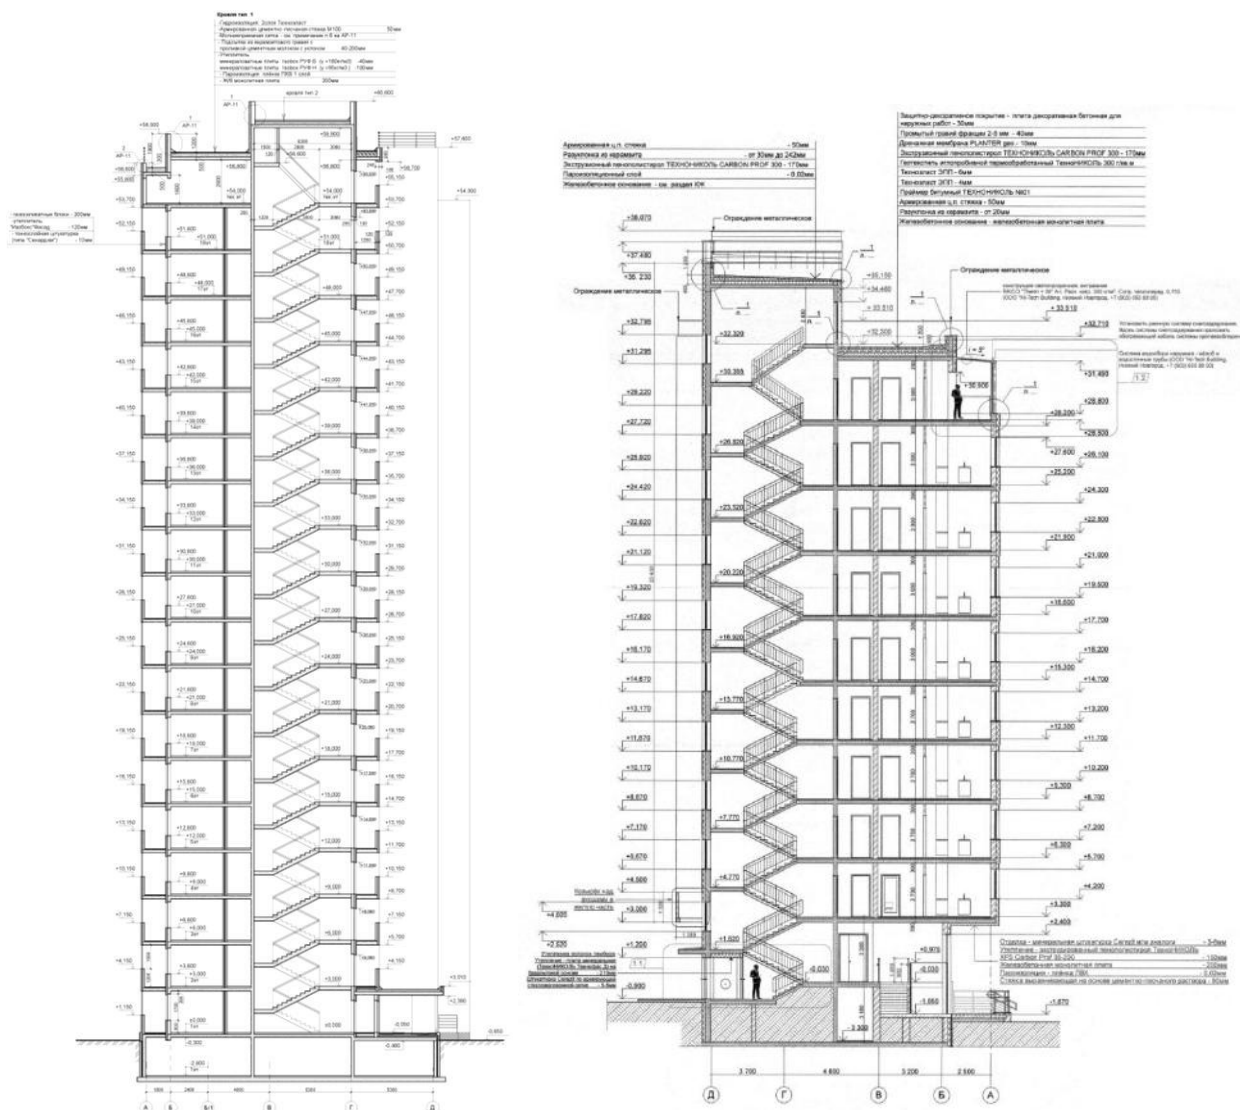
Разрез многоэтажного жилого дома по лестничной клетке типа Н1, Н2
